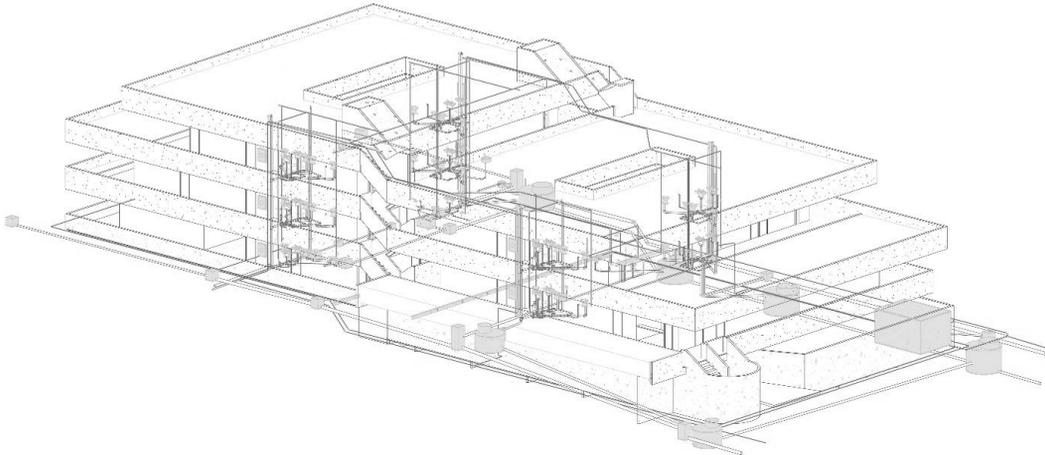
Modelo de Instalação Hidrossanitária BIM. Fonte: elaborado pelo autor
